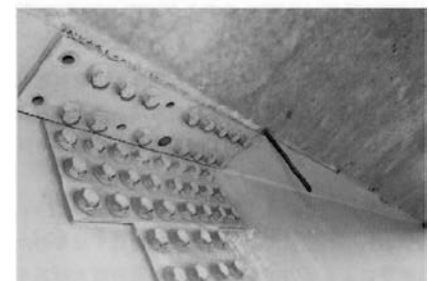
高力ボルトの脱落事例⁵⁾
